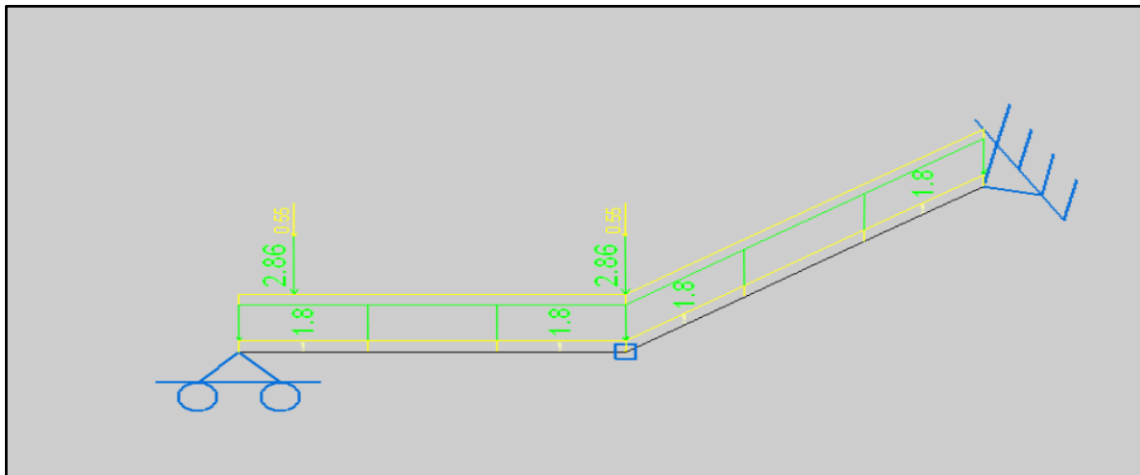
Cargas aplicadas sobre la viga B en Metal 3D
